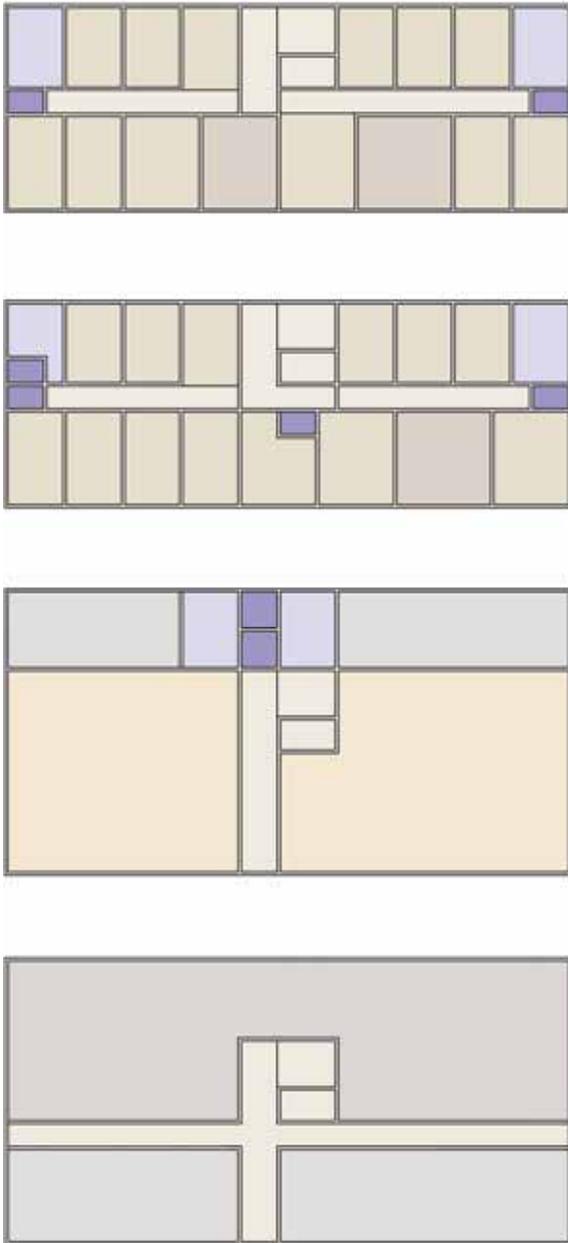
Grundrisse und Zonen des Geschäftsgebäudes (Bezeichnungen der Zonen sind noch nachzutragen).
